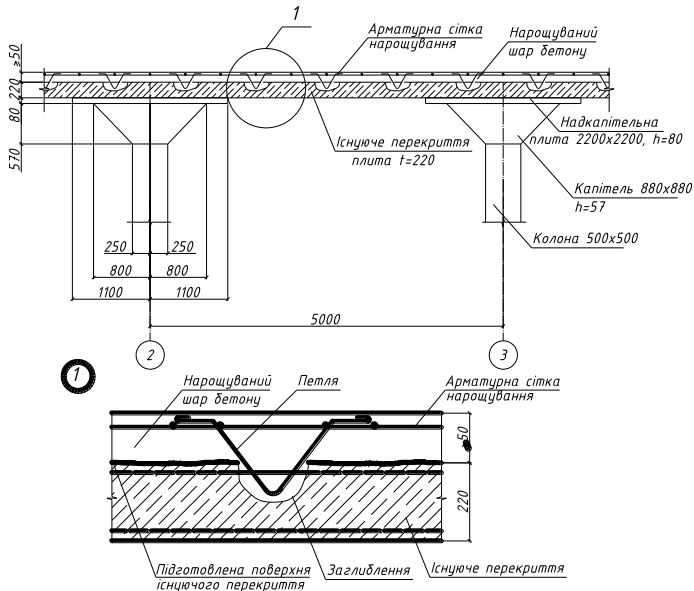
Забезпечення сумісної роботи старого і нового бетону шляхом влаштування залізобетонних шпонок
